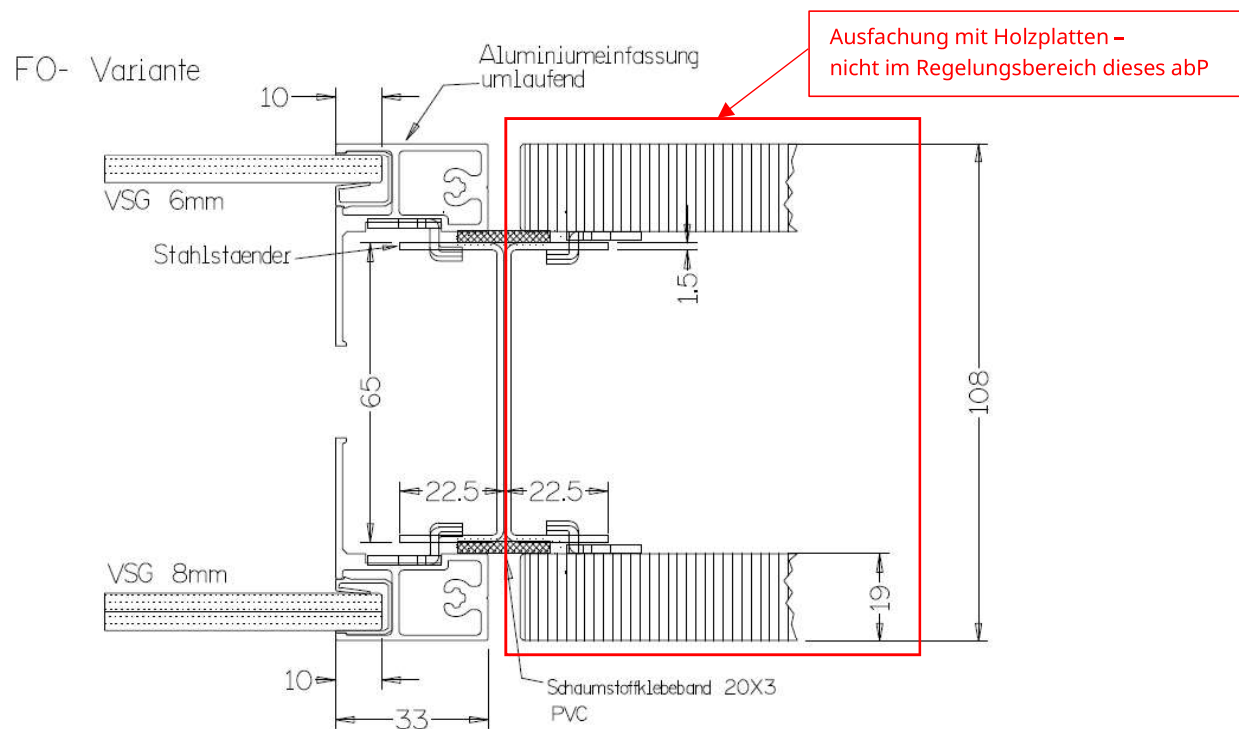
Horizontalschnitt Glasaufleger und Ständerprofil System Solid 05 – F0
